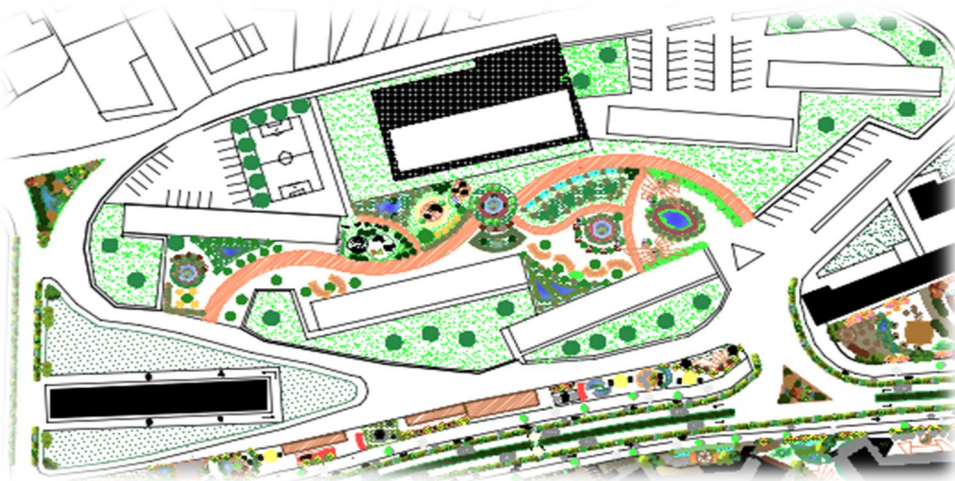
Vue en plan de la restructuration de la cite cinq juillet Source : auteurs
